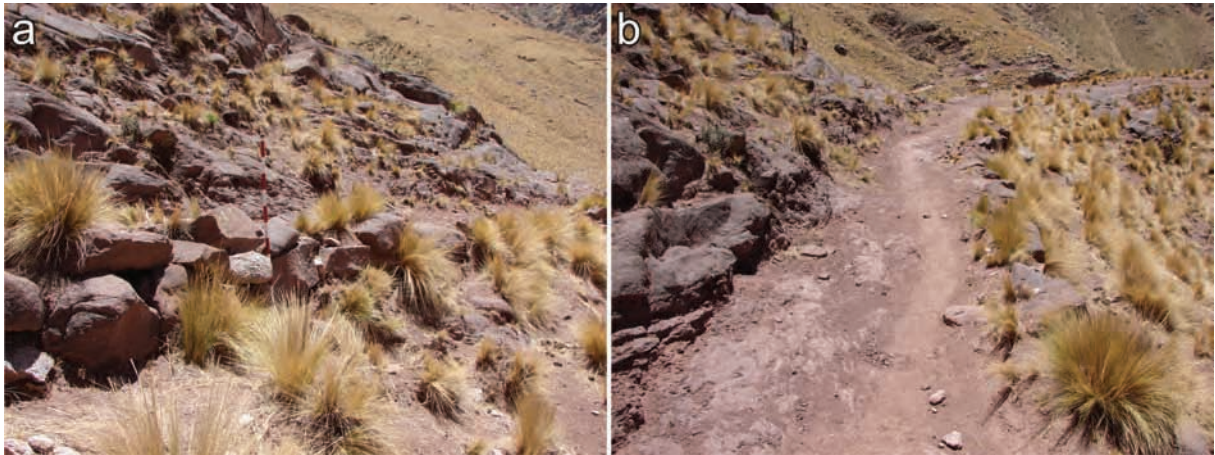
a) Pared exterior del muro de contención ladera abajo, algunas rocas "jaci" poseen evidencia de tallado; b) Vista de la traza vial y su trabajo de excavación en el interior de la ladera (sector izquierdo de la fotografía). Fotografías del autor.
